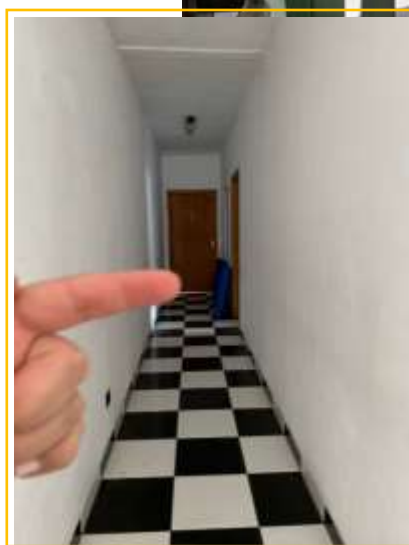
Detalhe de outro ambiente que está sendo utilizado para depósito 02.
